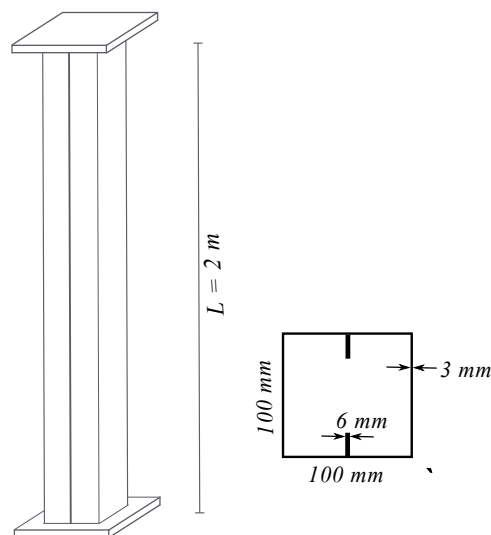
Dimensões do pilar ensaiado. Adaptado de Costa (2013).
